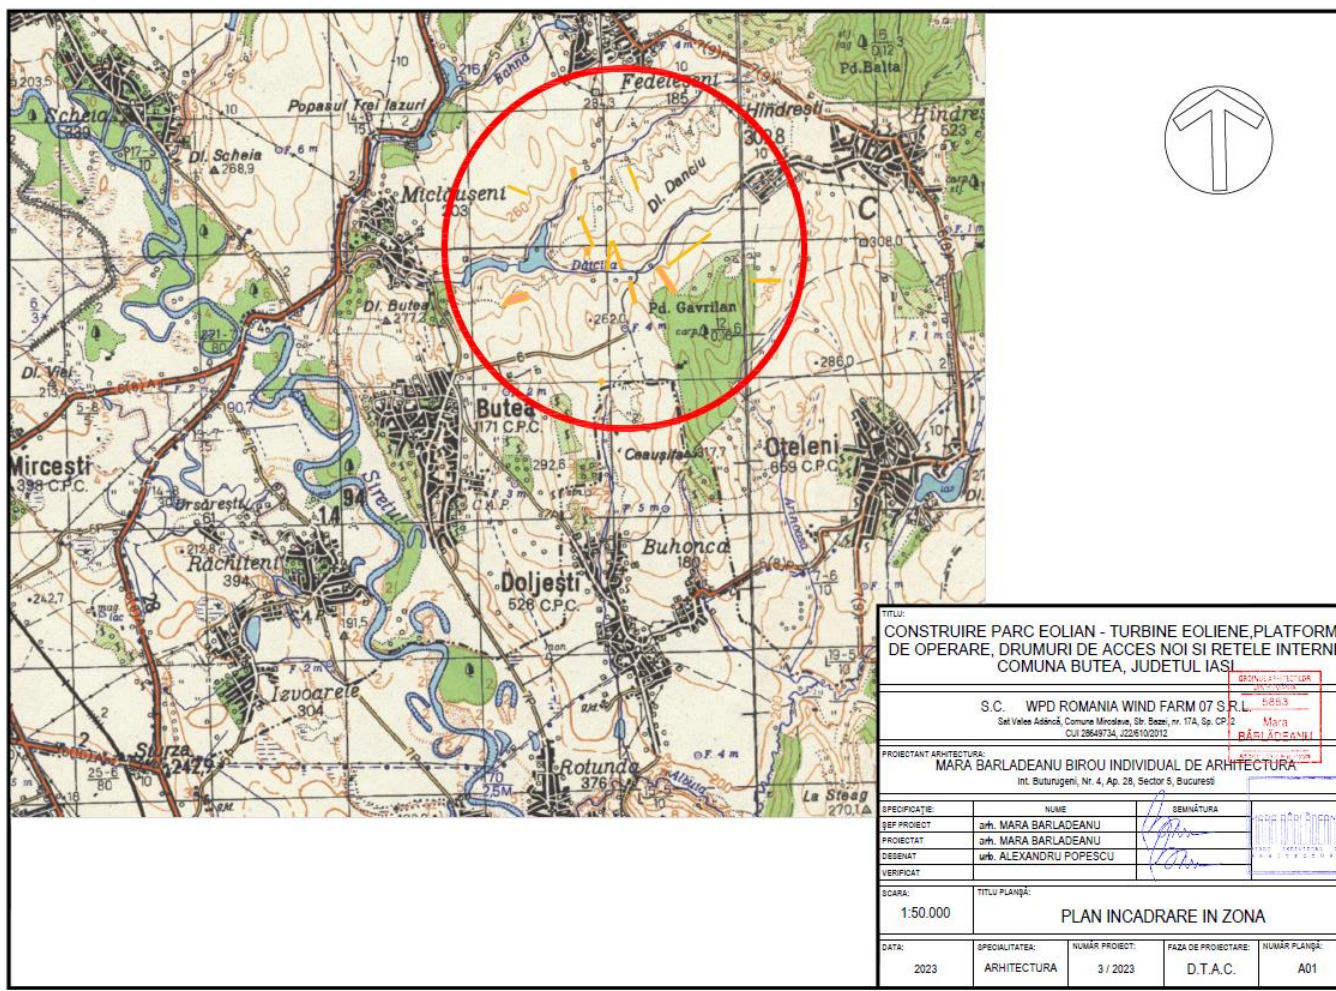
Plan de încadrare – Parc eolian BUTEA – încadrarea în zonă
